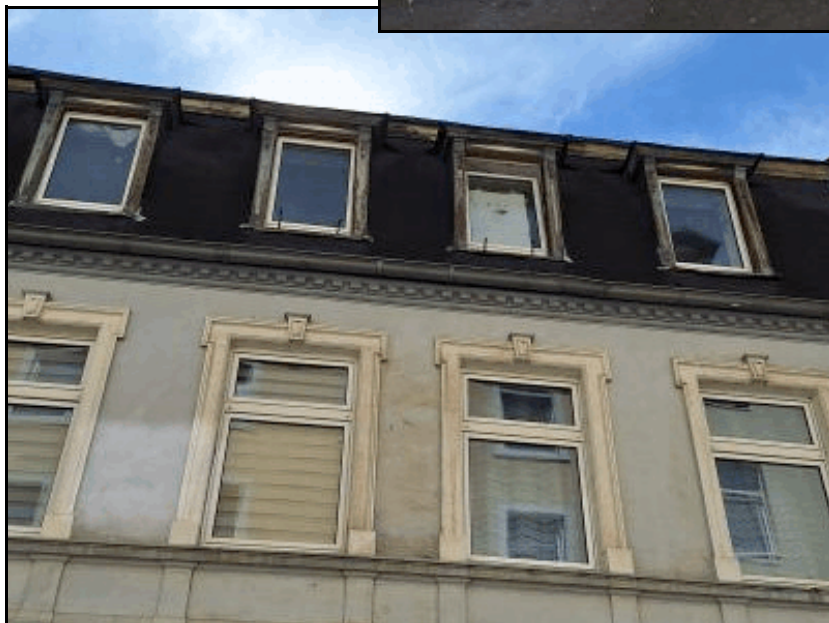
offenes Fenster im Mansardengeschoss, Nässeschäden im Obergeschoss
